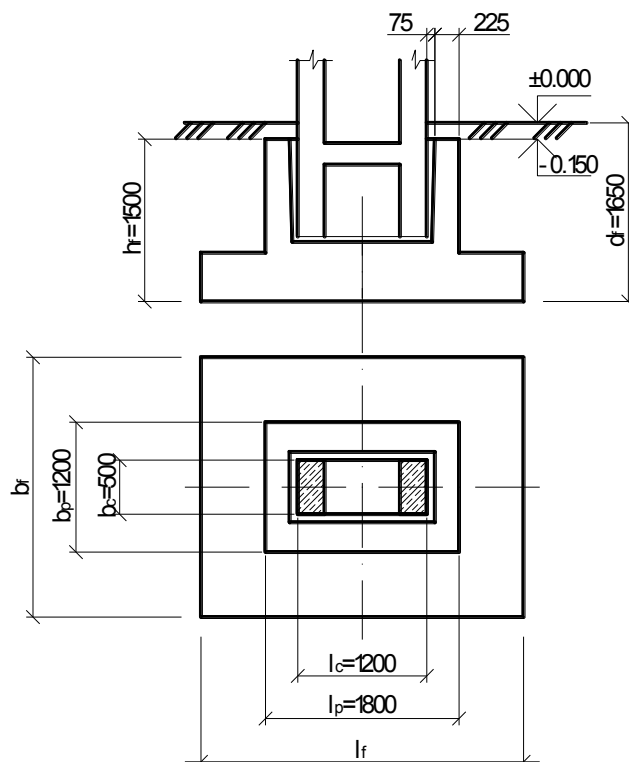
Схема столбчатого плитного внецентренно нагруженного фундамента под среднюю колонну
